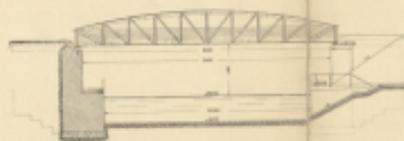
Querschnitt durch die Brücke und Profil gegen die Pfeiler.
